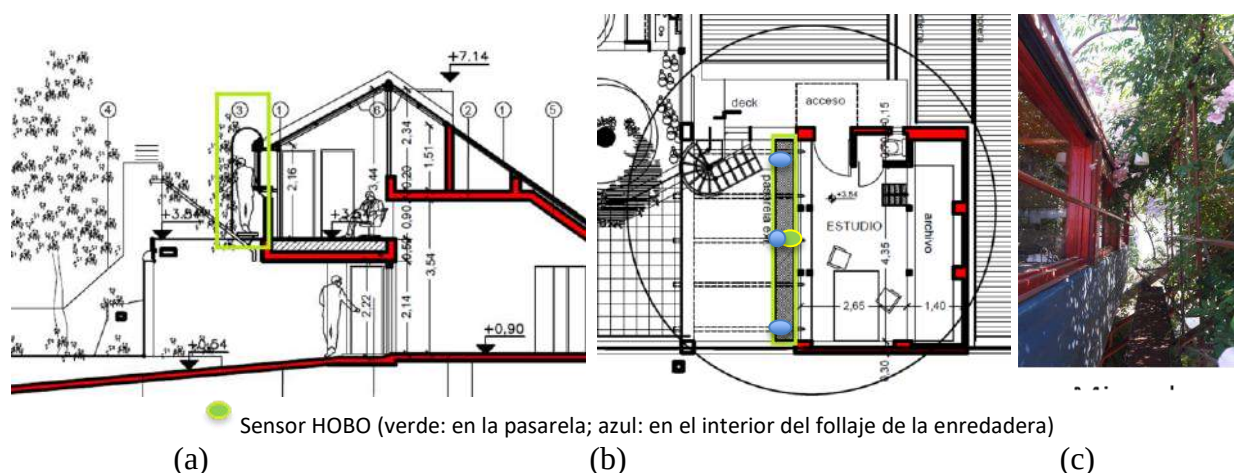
doble fachada monitoreada, en donde se observa la planta y corte de la ubicación de la doble fachada en la planta alta de la vivienda (a y b) y la ubicación del sensor de medida en la pasarela (c).
